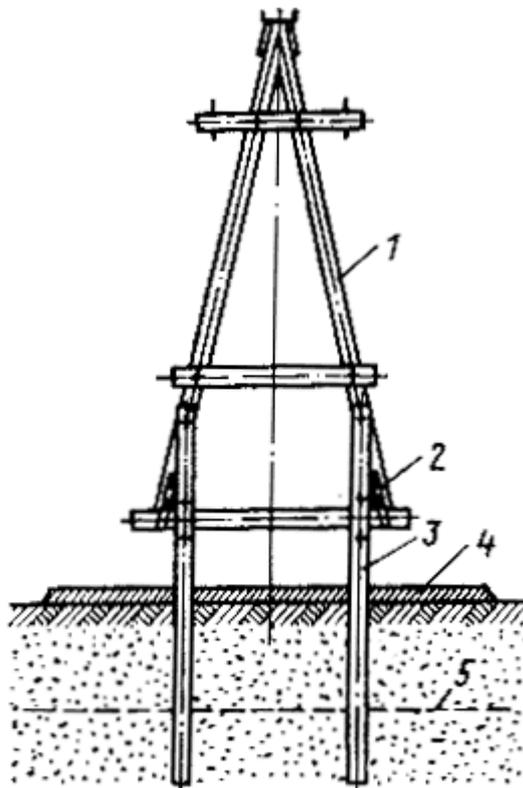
Установка А - образной опоры ВЛ 6-10 кВ на деревянных сваях в вечномёрзлом грунте:
